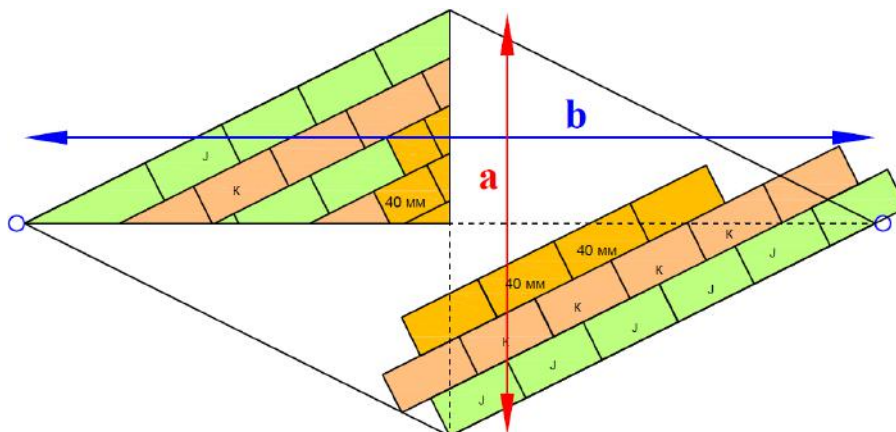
Схема раскладки плит PIR SLOPE 3,4% при создании разуклонки между воронками в ендове
